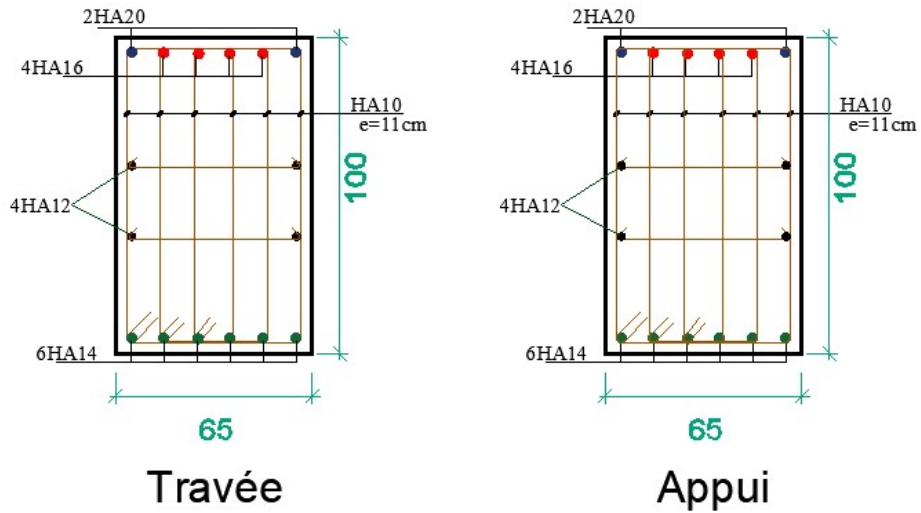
Ferrailage de la Nervure suivant x-x.
